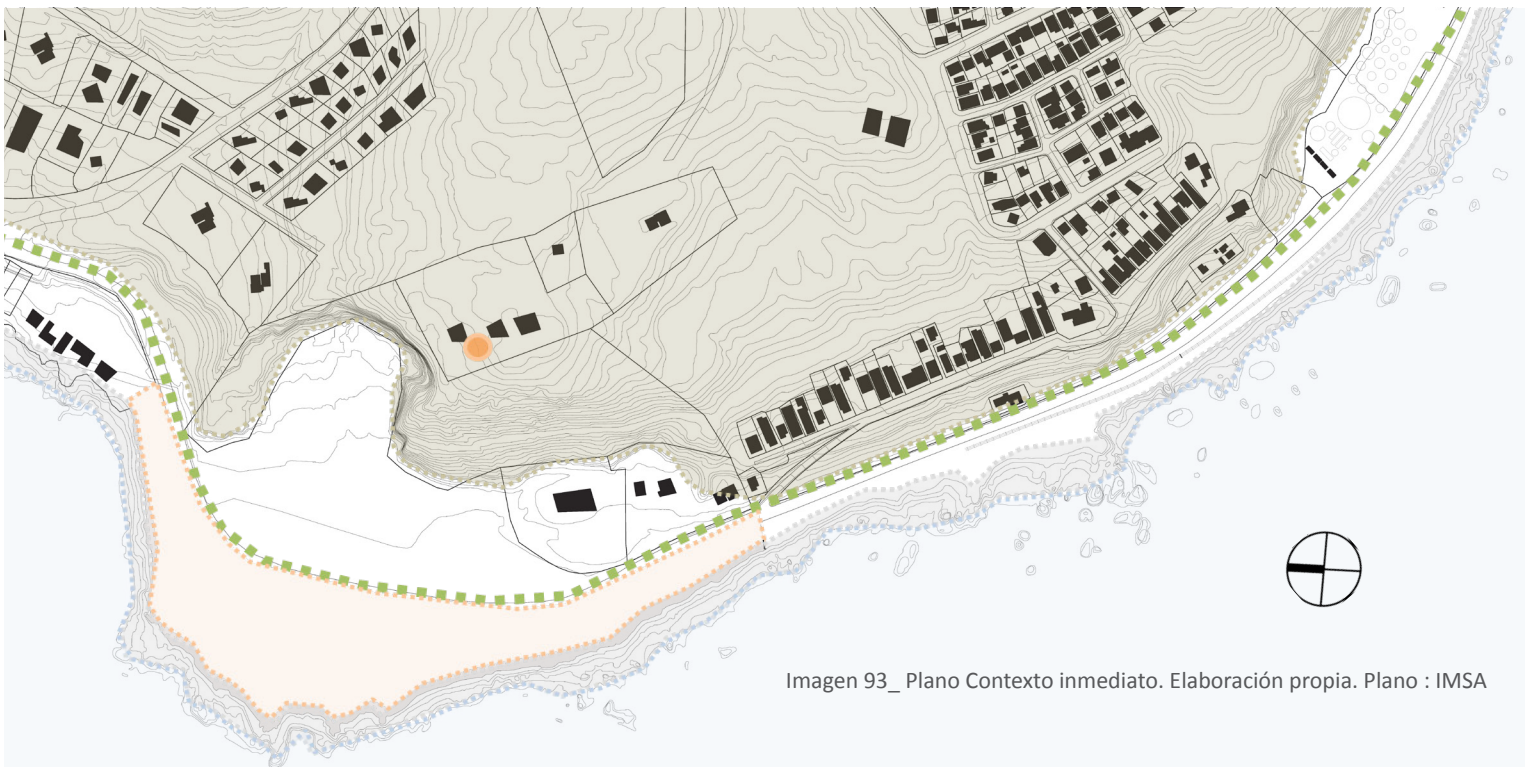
Plano Contexto inmediato. Elaboración propia. Plano : IMSA
